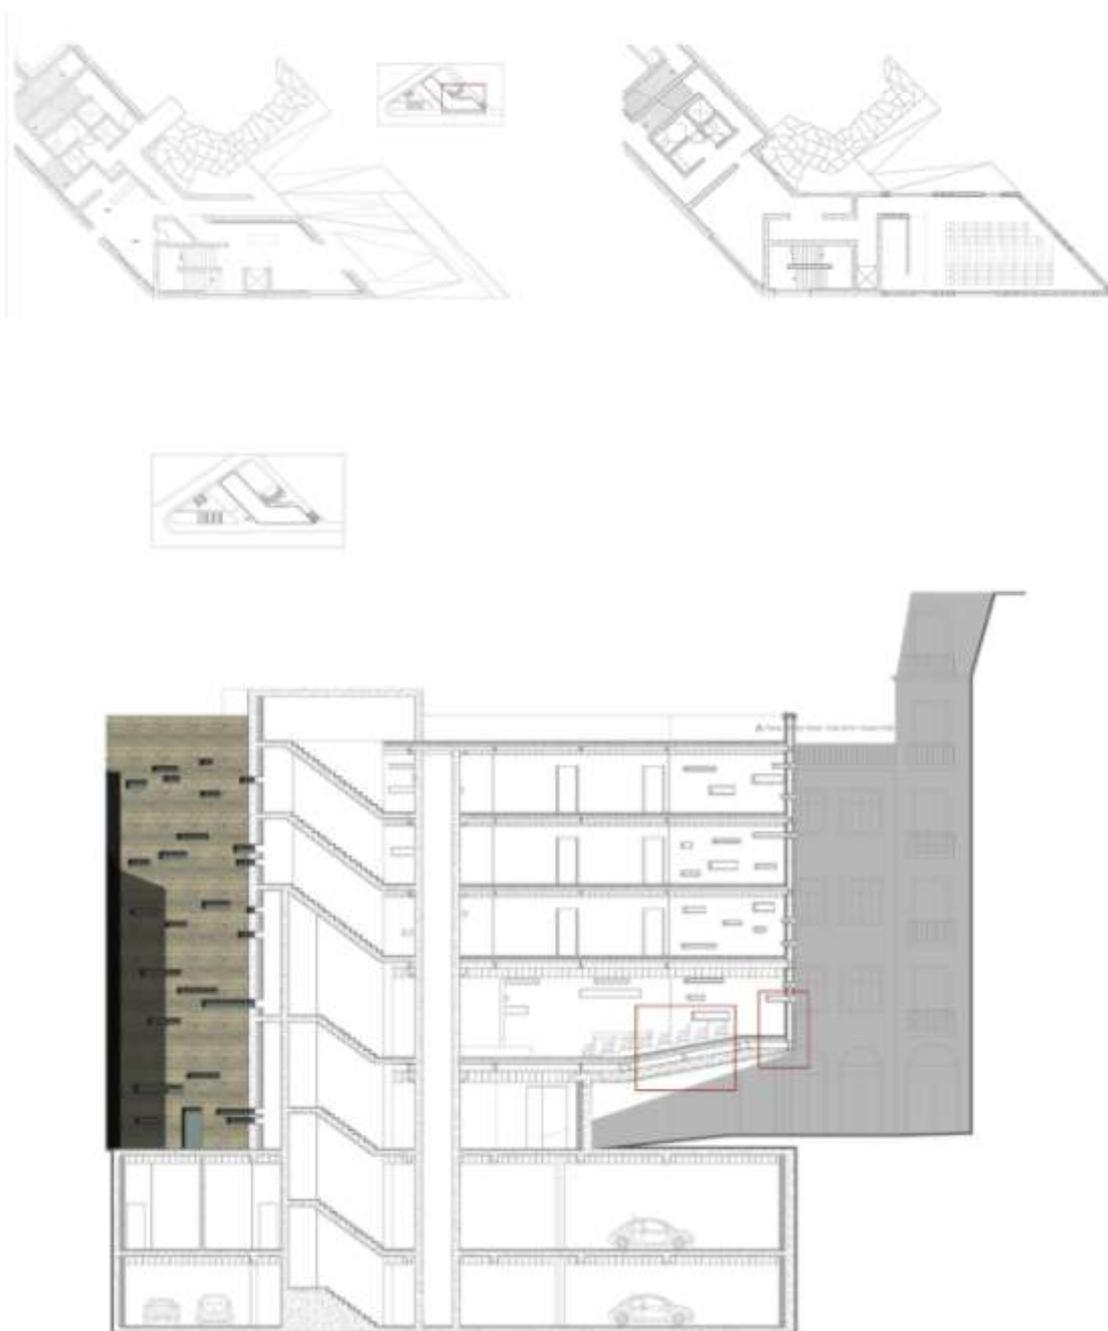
Plantas e corte construtivo. (Ilustração nossa, 2013)
